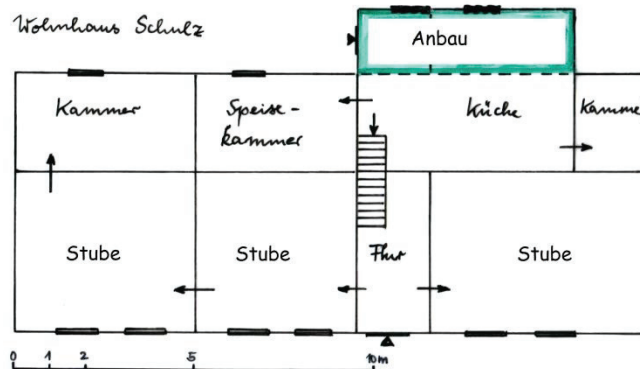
Grundriss ehemaliges Wohnhaus Schulz, nachträglicher Anbau grün gekennzeichnet, Grundriss erhalten, Haus unbewohnt
